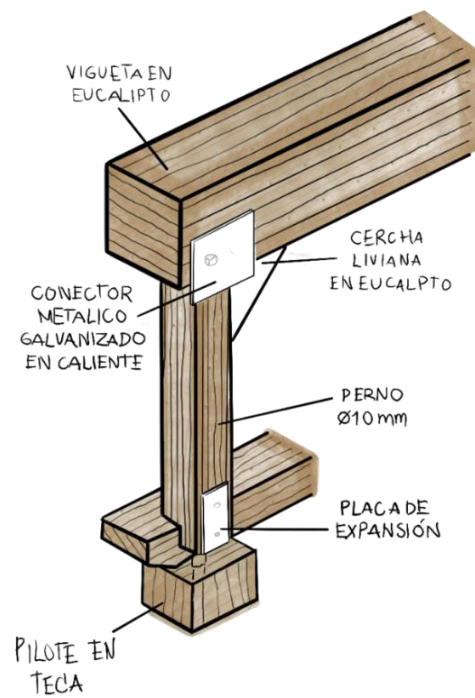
Detalle constructivo de la estructura en madera con base a la información extraída anteriormente- Autoría propia
